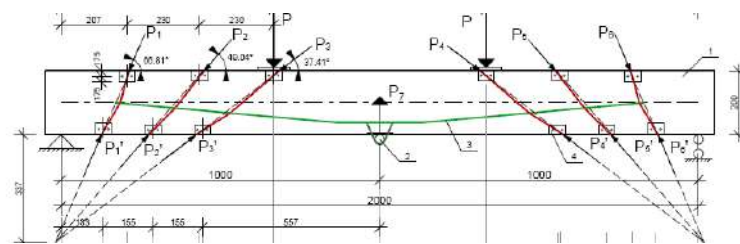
Регульовано напружена залізобетонна балка з розташуванням похилої арматури під різним кутом.
